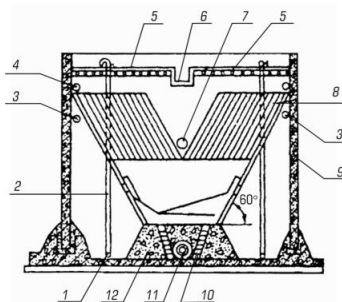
Тонкослойный отстойник: 1 - труба для удаления осадка; 2 - труба для выпуска воздуха; 3, 7 - отвод осветленной воды из осадкоуплотнителя; 4 - трубопровод подогрева; 5 - отверстия в поперечных сборных желобах; 6 - сварной лоток; 8 - многослойная загрузка; 9 - корпус; 10 - кирпичная кладка; 11 - подвод воды в секцию; 12 - гравийная камера хлопьеобразования.
